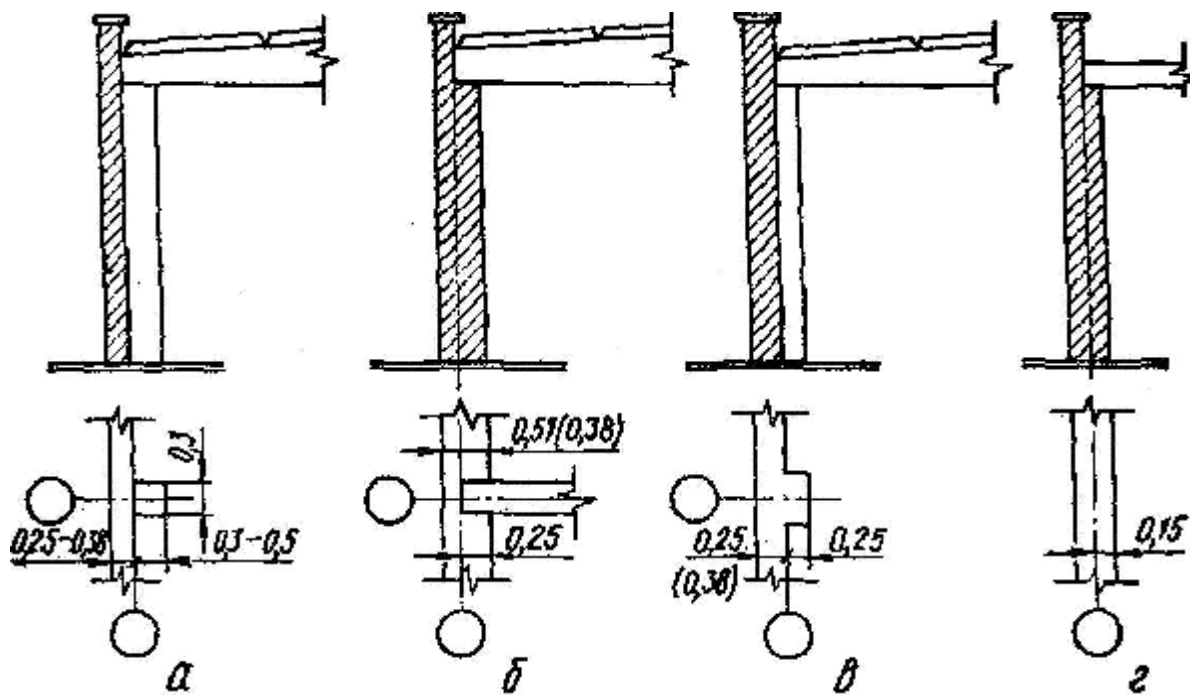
Схемы привязки наружных стен к продольным разбивочным осям:
